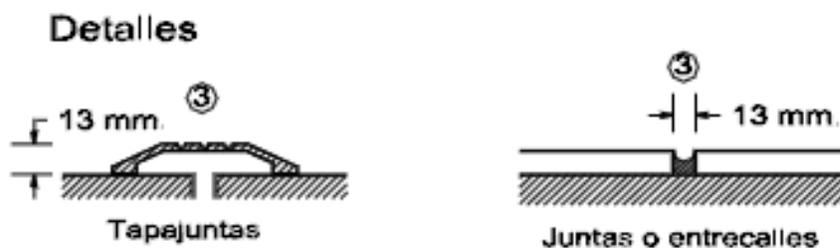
Detalles de tapajuntas del lado izquierdo y las juntas del lado derecho.
